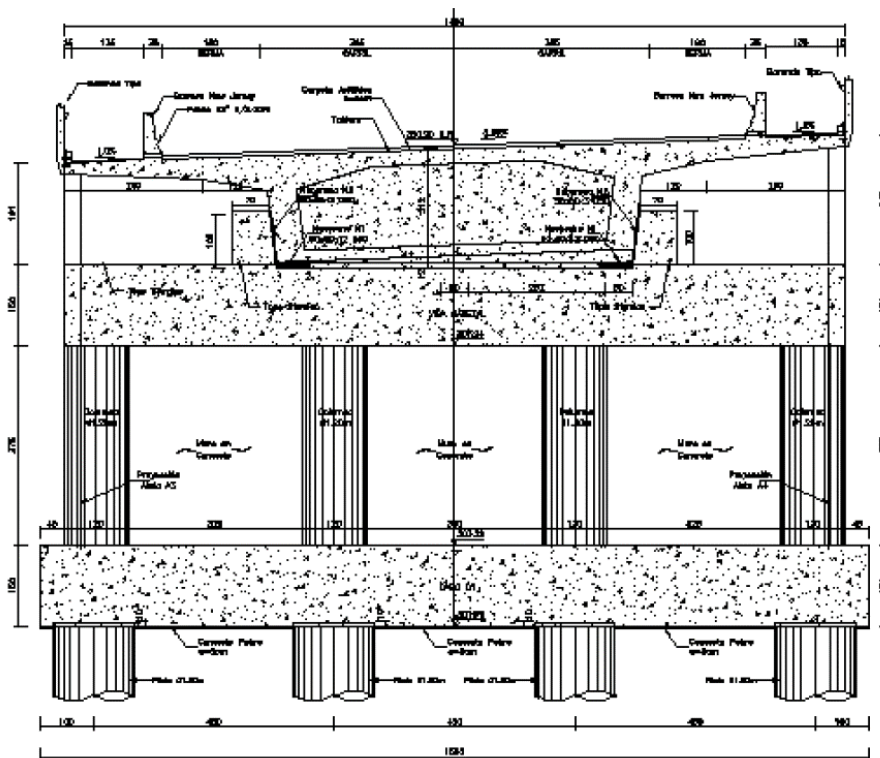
Geometría del apoyo eje 6 puente San Pedro.
